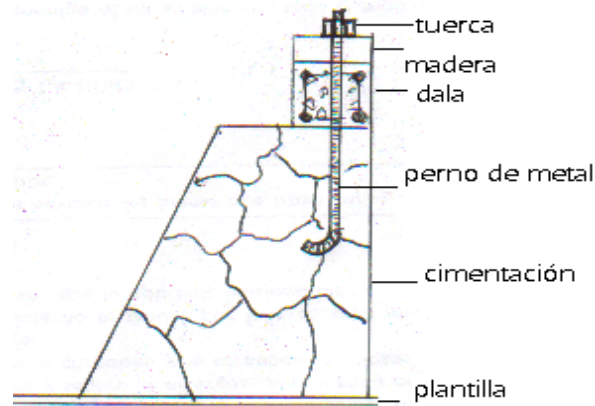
Zapata corrida de mampostería, dala, solera de madera tratada CCA, espárrago ahogado en la cimentación con tuerca y roldana.
